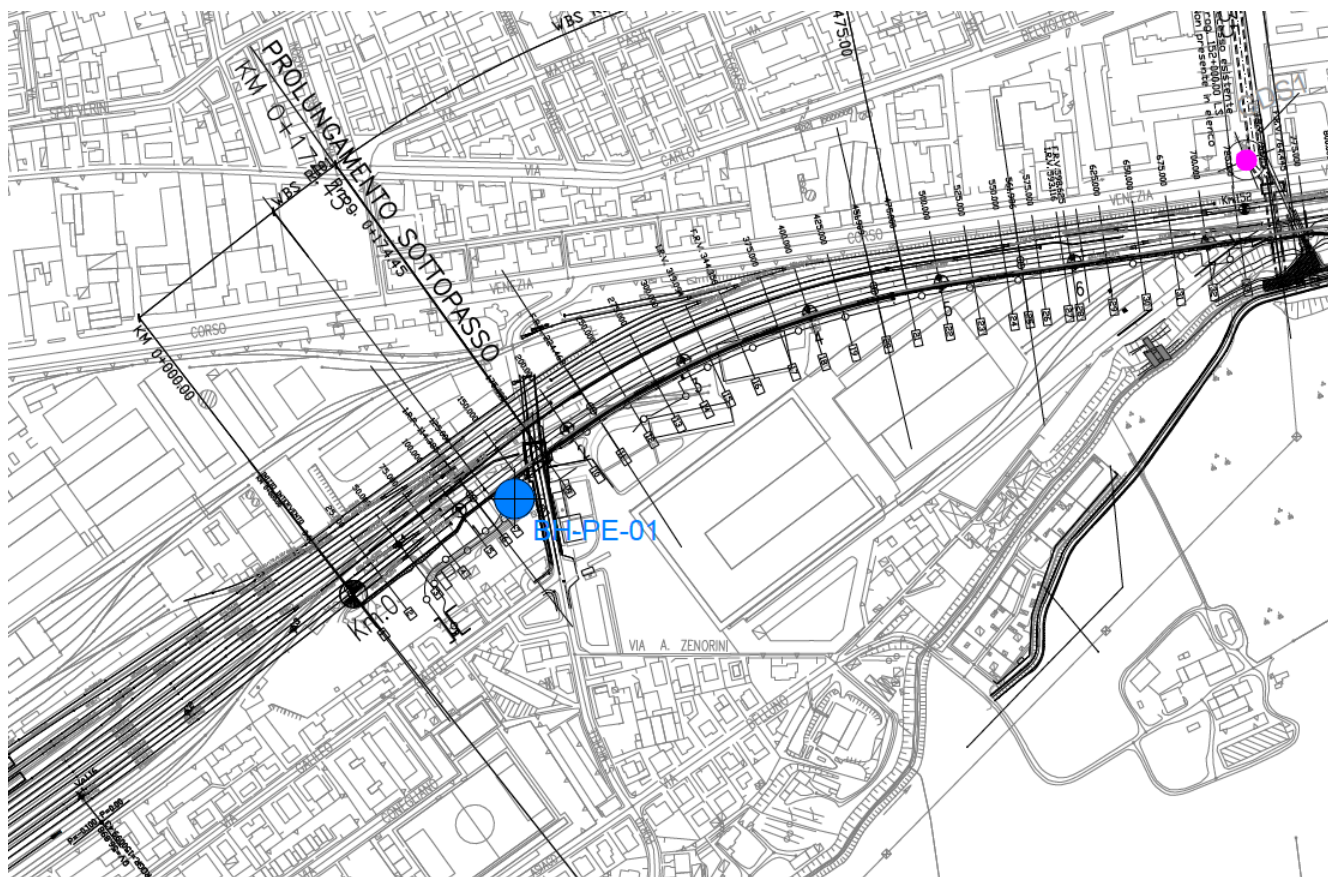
Stralcio planimetrico – Ubicazione indagini geotecniche di riferimento per l’opera in esame
